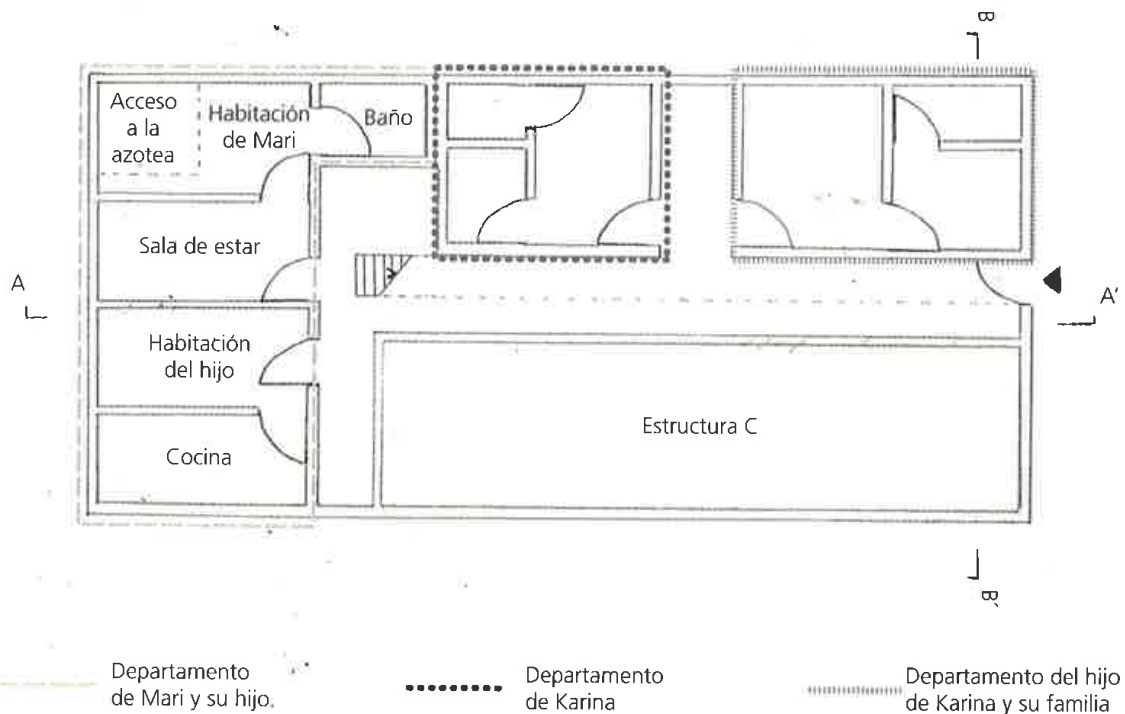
Planta baja de la casa familiar de los Ornelas Rubio
